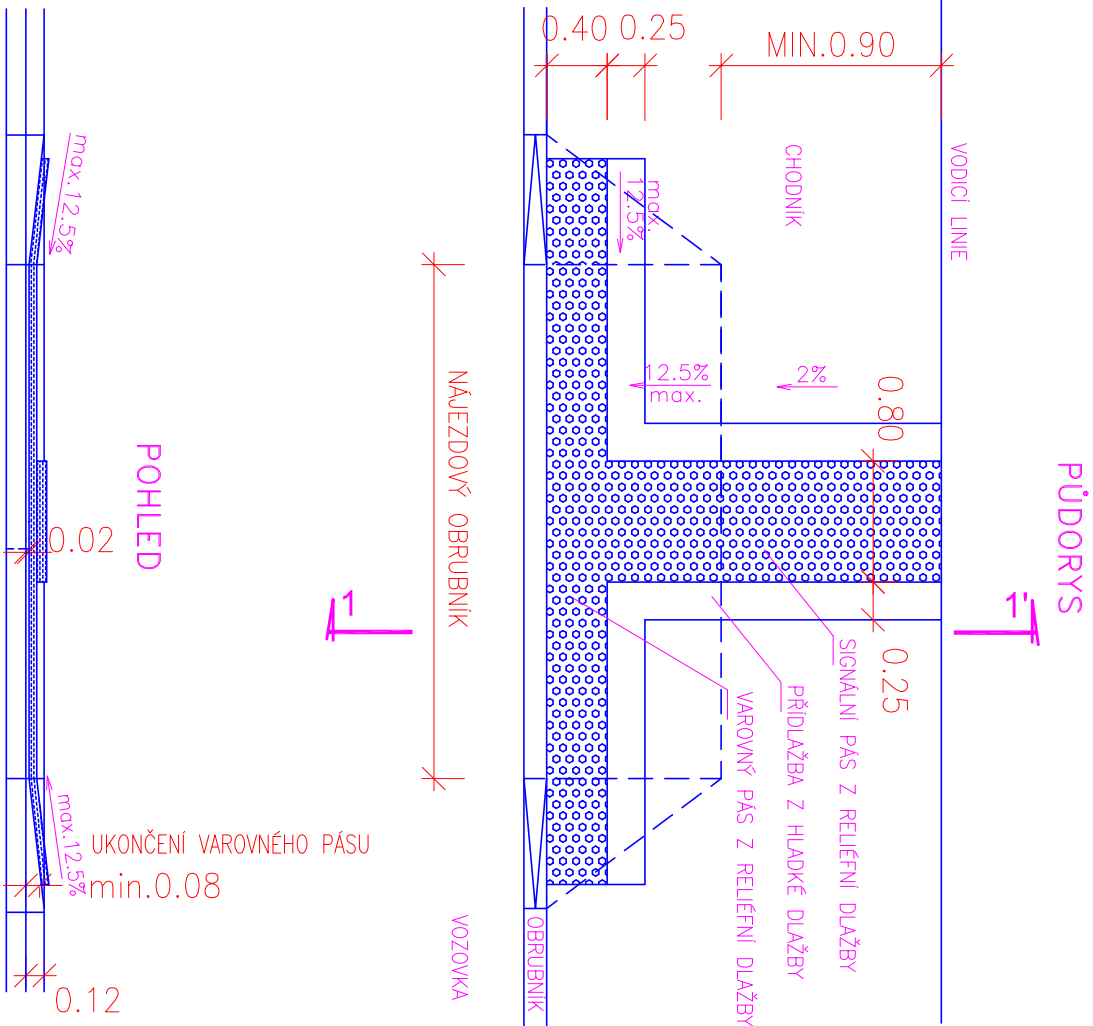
## DETAIL VIZUÁLNÍ ÚPRAVY PŘI HRANĚ ZASTÁVKY
